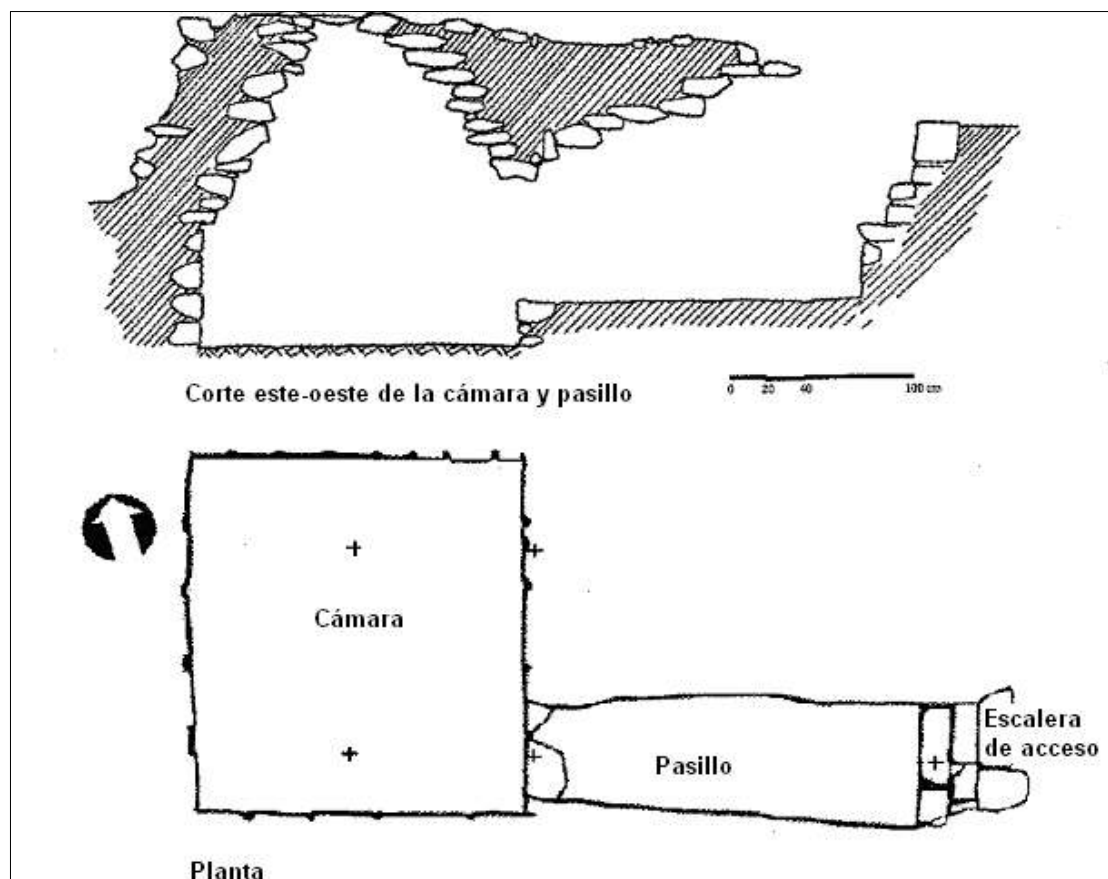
Cortes estructurales del temazcal excavado y registrado en Cuchitepanco N4E3 (retomado de Ortega, et al., 2008: 72 y 78)
